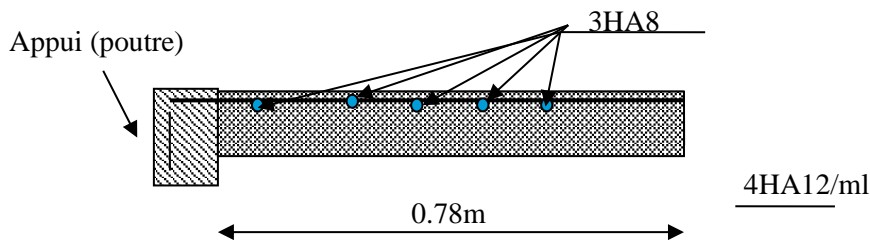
Schéma de ferrailage de dalle pleine sur 2 appuis (D3)
